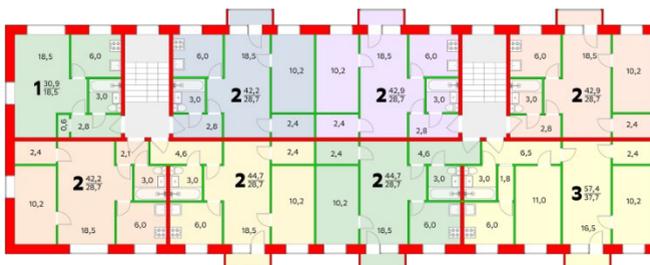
План этажа серии 1-447 (красным выделены несущие стены)
